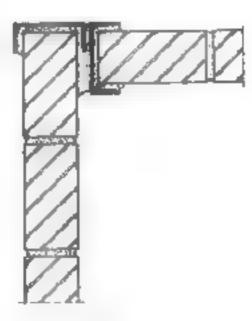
LIGAÇÃO DE CANTO DA ALVENARIA NA ESTRUTURA. PAREDE DE 15 cm.
